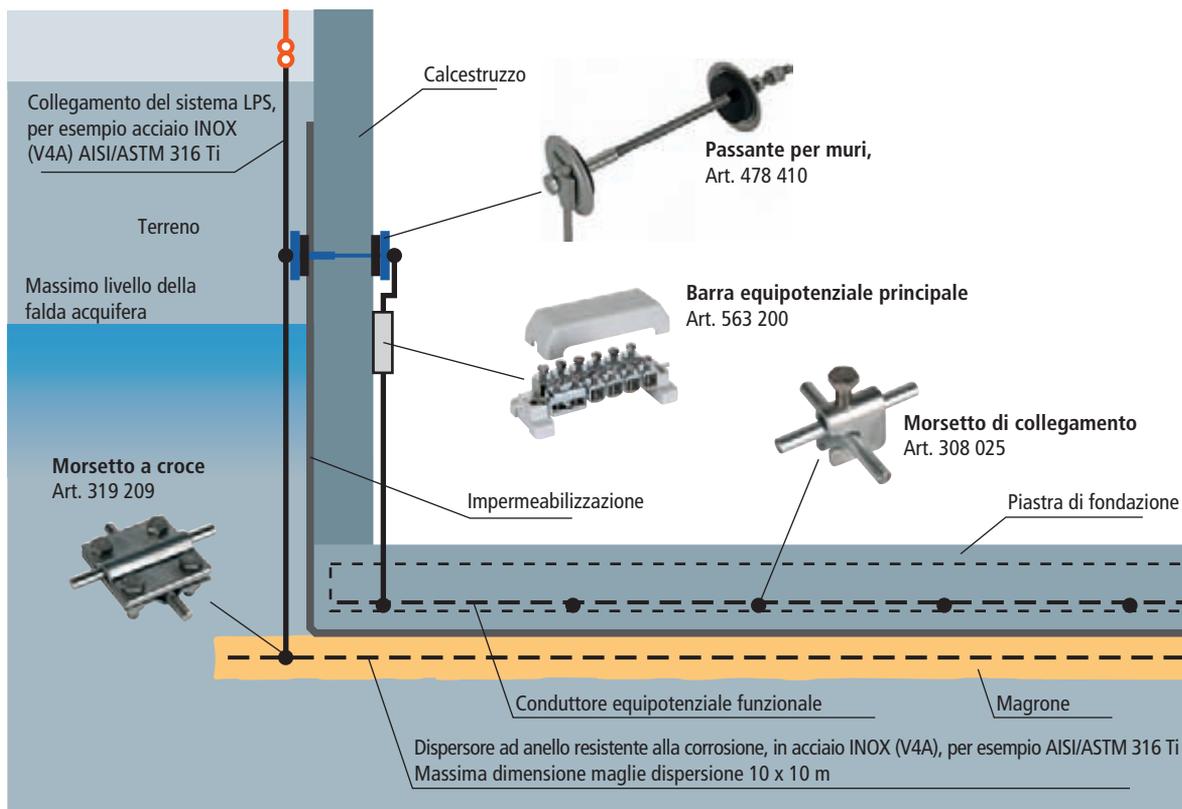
Disposizione del dispersore di fondazione con platea di fondazione chiusa "vasca nera"
